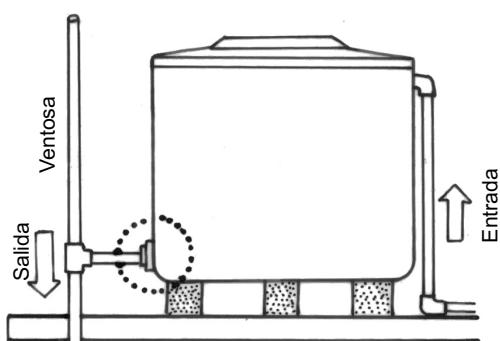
Instalaciones hidráulicas a un tanque elevado
